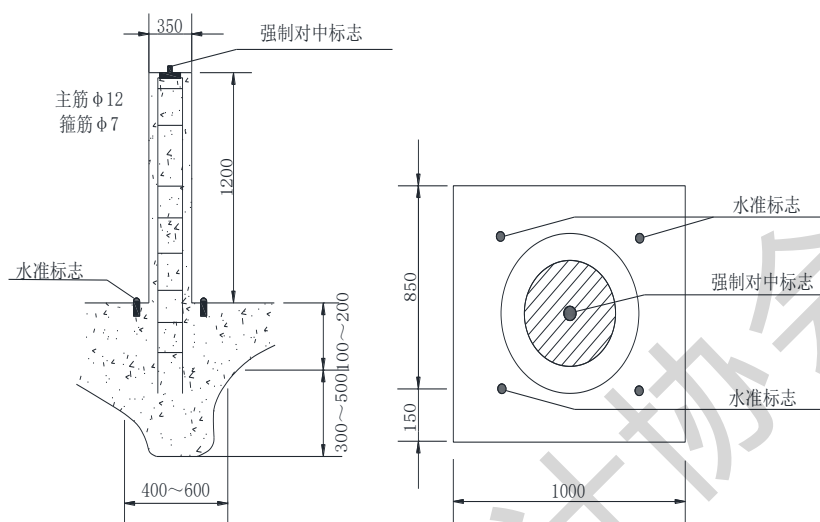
岩层水平位移观测墩剖面图与俯视图 (单位: mm)
